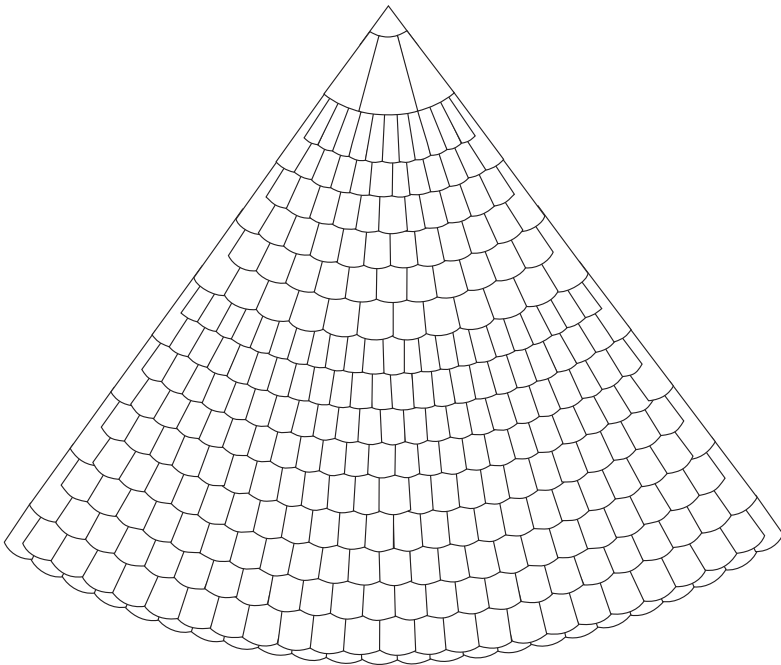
Nanoszenie powierzchni dachu do wyznaczenia wykreju stożkowego przy 60° nachylenia dachu
